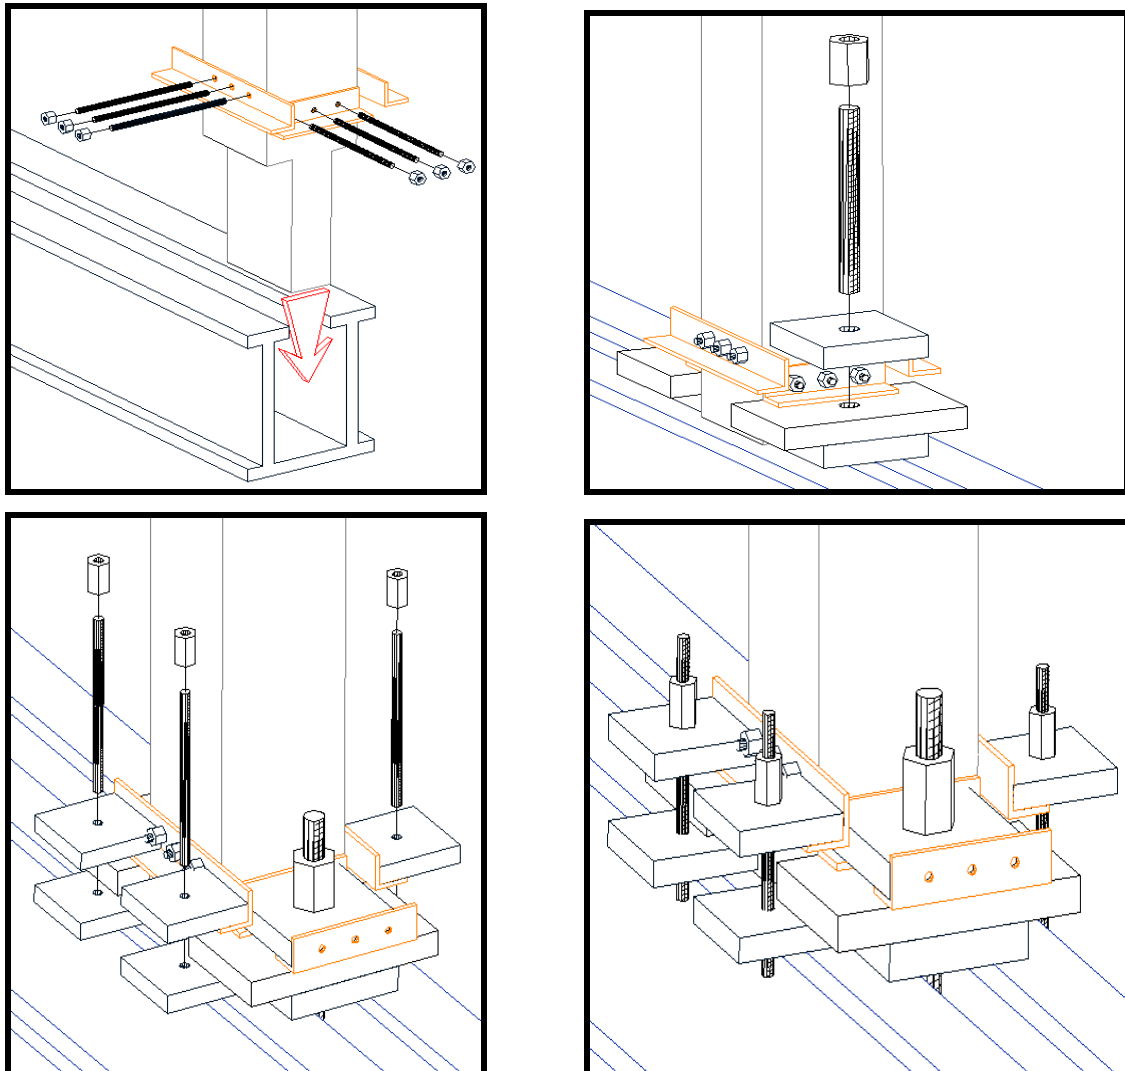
Esquema de encaixe e travamento da base do pórtico no perfil metálico da laje de reação
